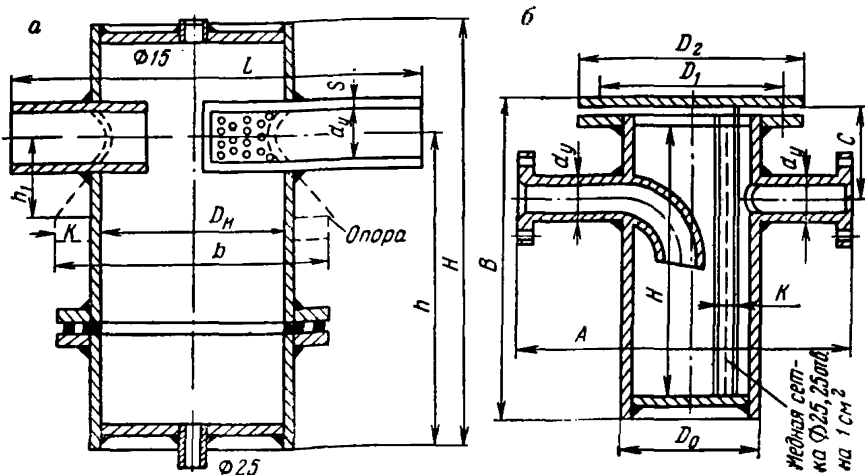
Конструкции (а — Сантехмонтажпроект; б — с сеткой в корпусе) и схемы грязевиков
